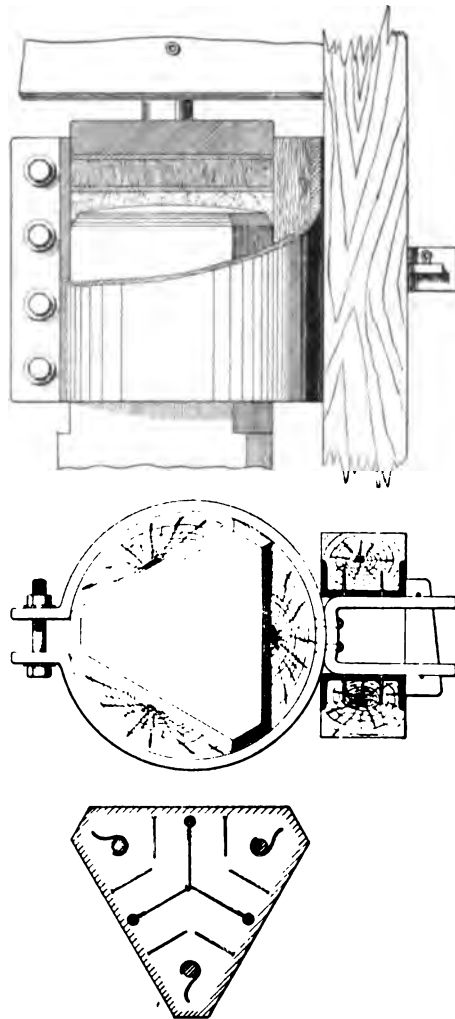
Eisenbetonpfahl mit dreieckigem Querschnitt.
